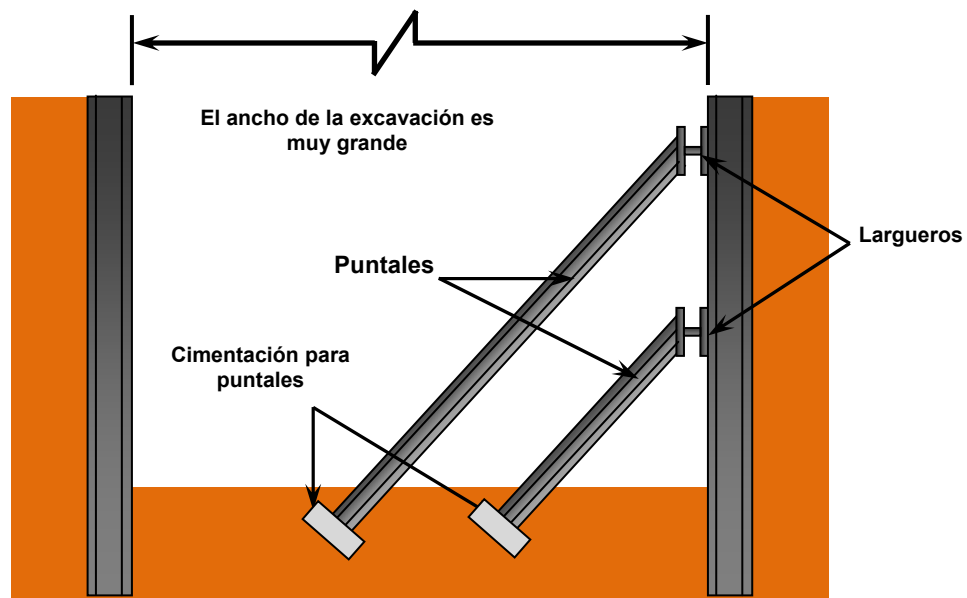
Sistema de puntales inclinados en un corte de excavación muy ancho.
